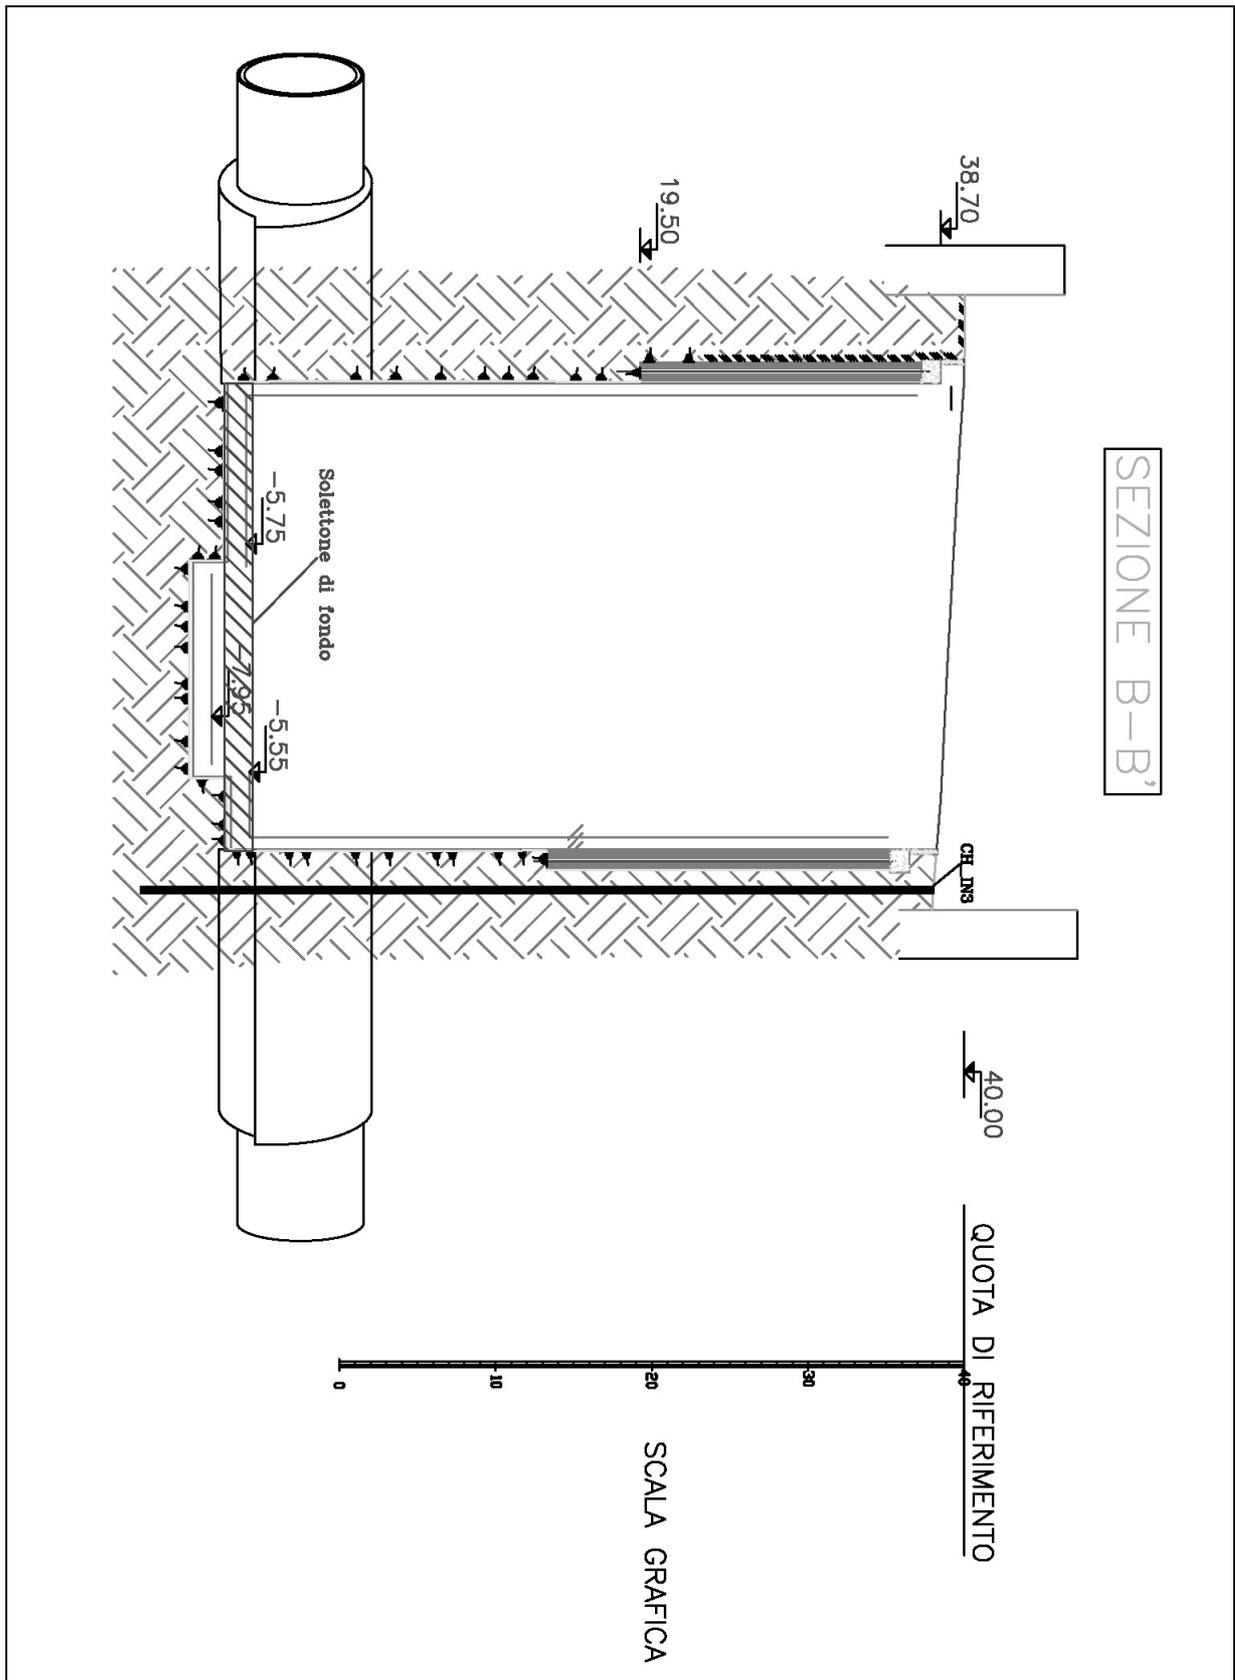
Sezione B-B' pozzo stazione, raffigurante la suddivisione in aree di lavoro.
